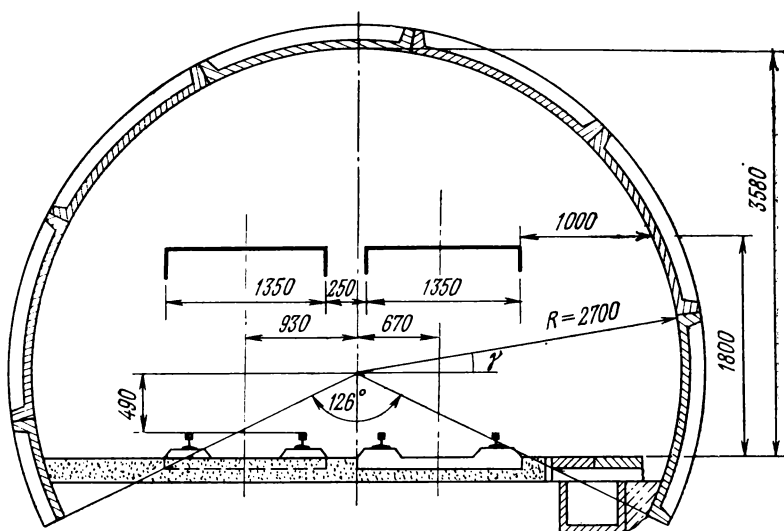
Сечение Б—Б сборной железобетонной крепи (см. рис. 83)
